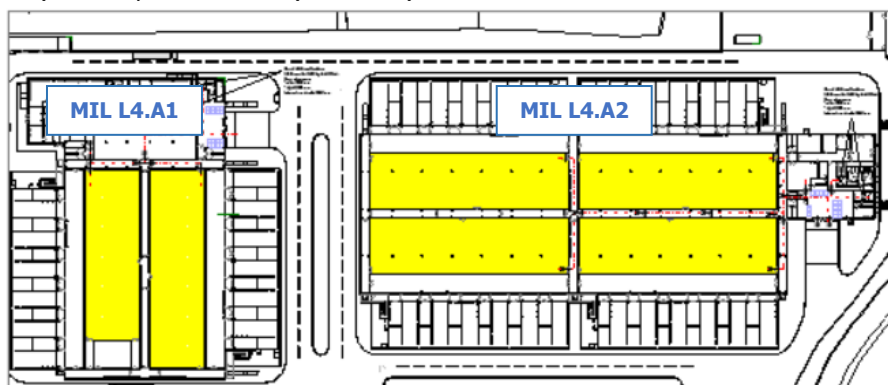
Planimetria Piano terra con evidenza delle sale dati presenti negli edifici
